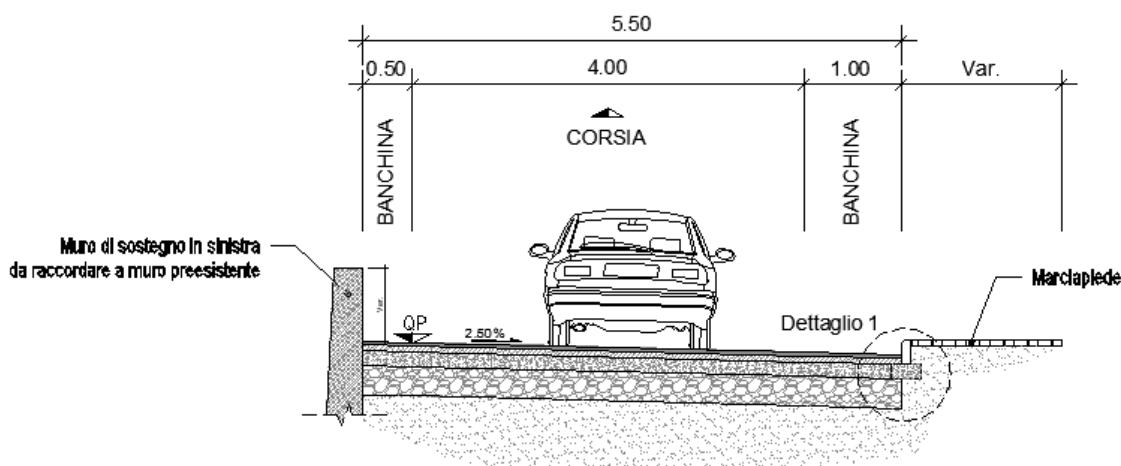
sezione tipo con nuovo muro di sostegno in sinistra
